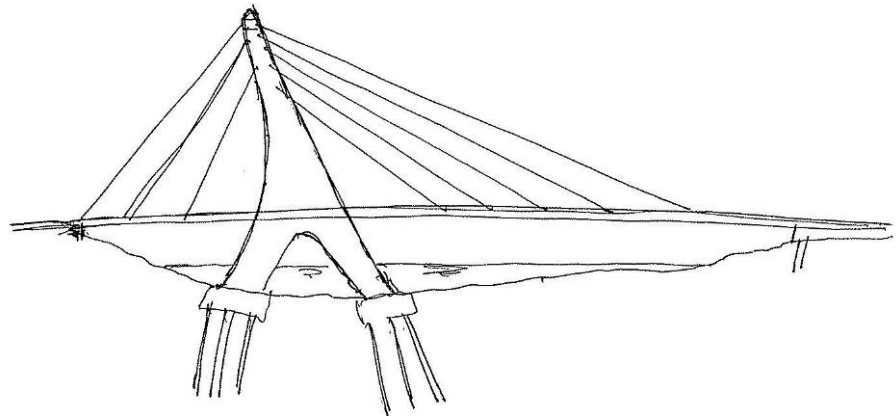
Puente atirantado. Tramo recto auxiliado por una familia de cables que concentran sus esfuerzos en un pilono.
